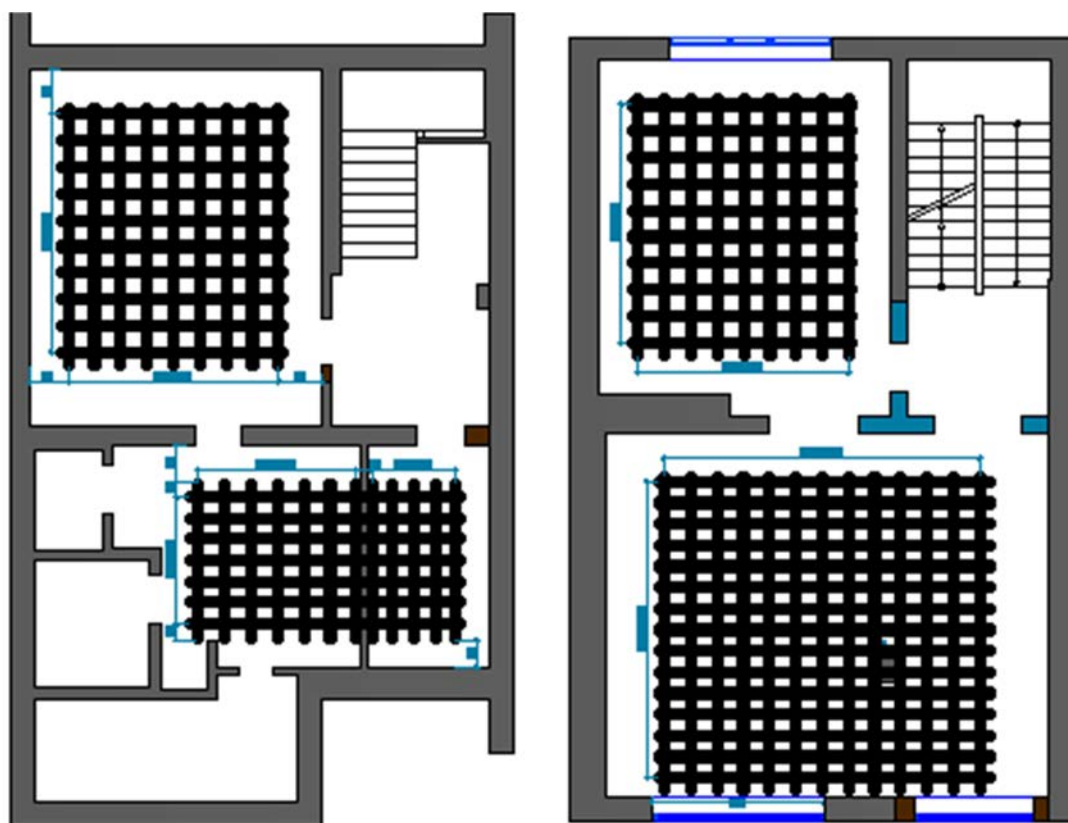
Схема усиления плит перекрытий над цокольным и вторым этажами жилого дома на пр. Достык, г. Алматы
